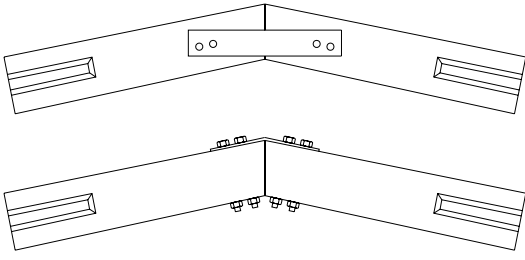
Pórtico principal com sistema de ligação viga-pilar com chumbadores e consolo inclinado. (Adaptado de [www.predalle.com.br](http://www.predalle.com.br)).
